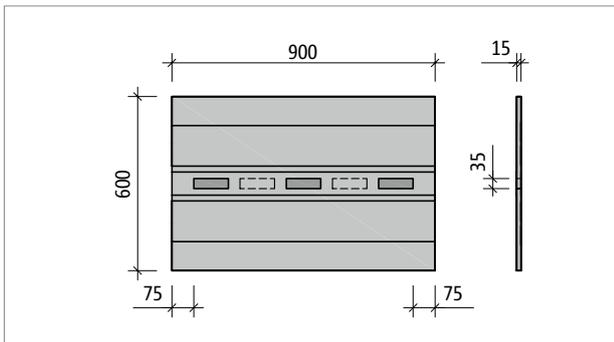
Schöck Tronsole® Typ B-V1...-B600: Produktgrundriss
